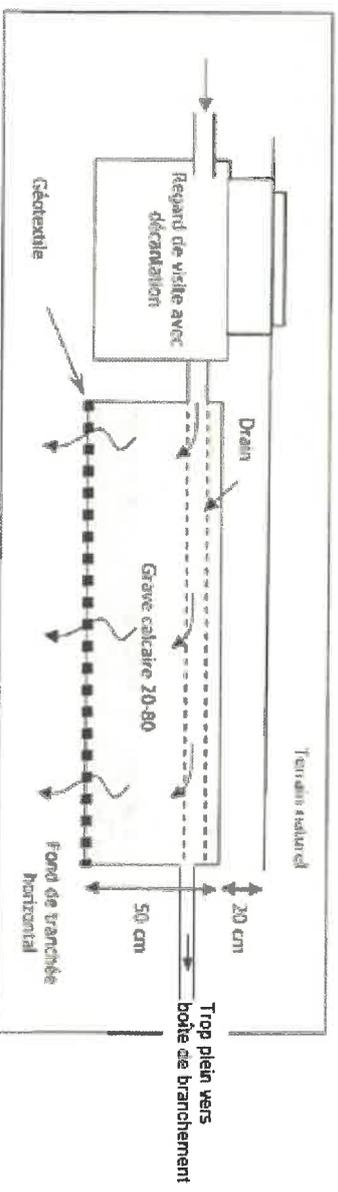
Principe de fonctionnement d'une tranchée d'infiltration
